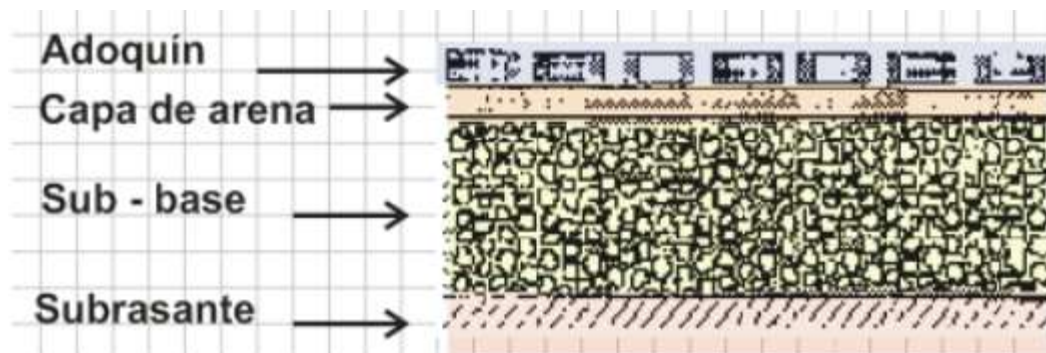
Sección de pavimento Articulado o Adoquinado. (Fuente: Manual para la revisión de diseño de pavimentos)
